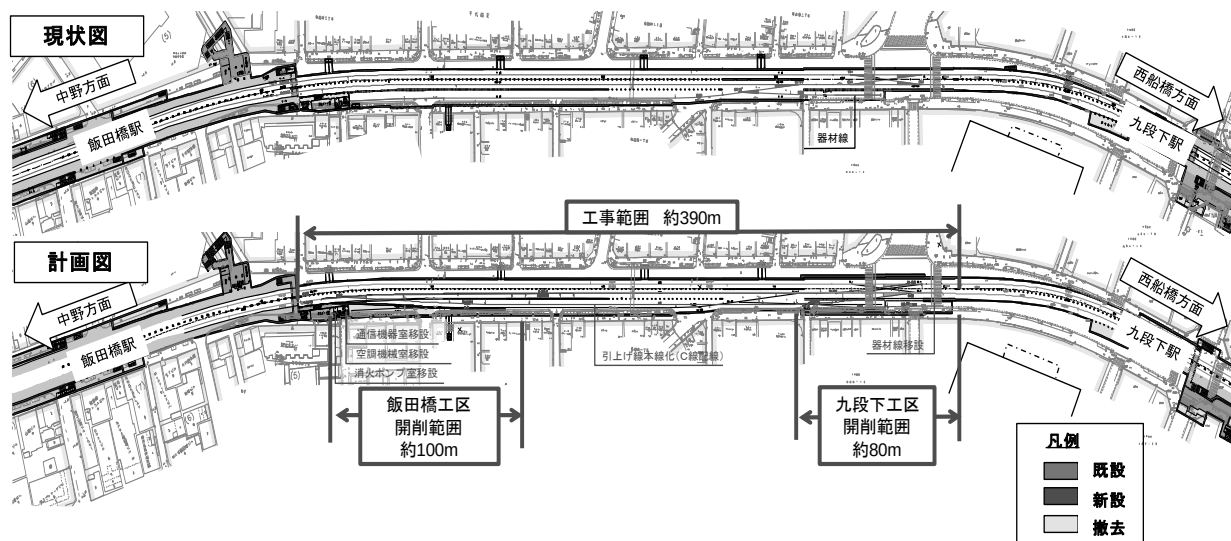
飯田橋～九段下駅間平面図（現況・改良後）
